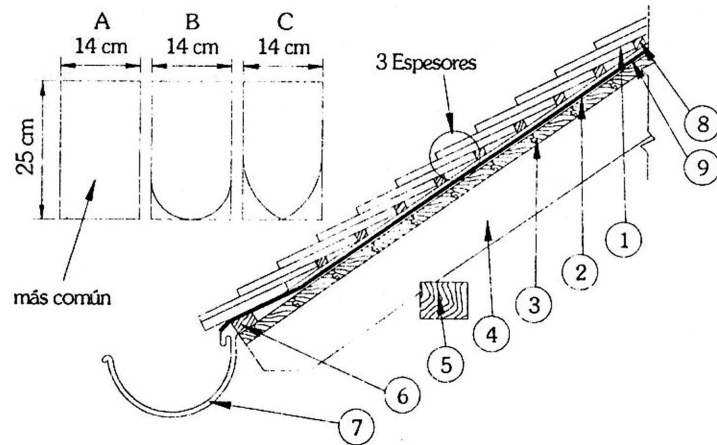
Cubierta de tejas planas o normandas (corte transversal).
